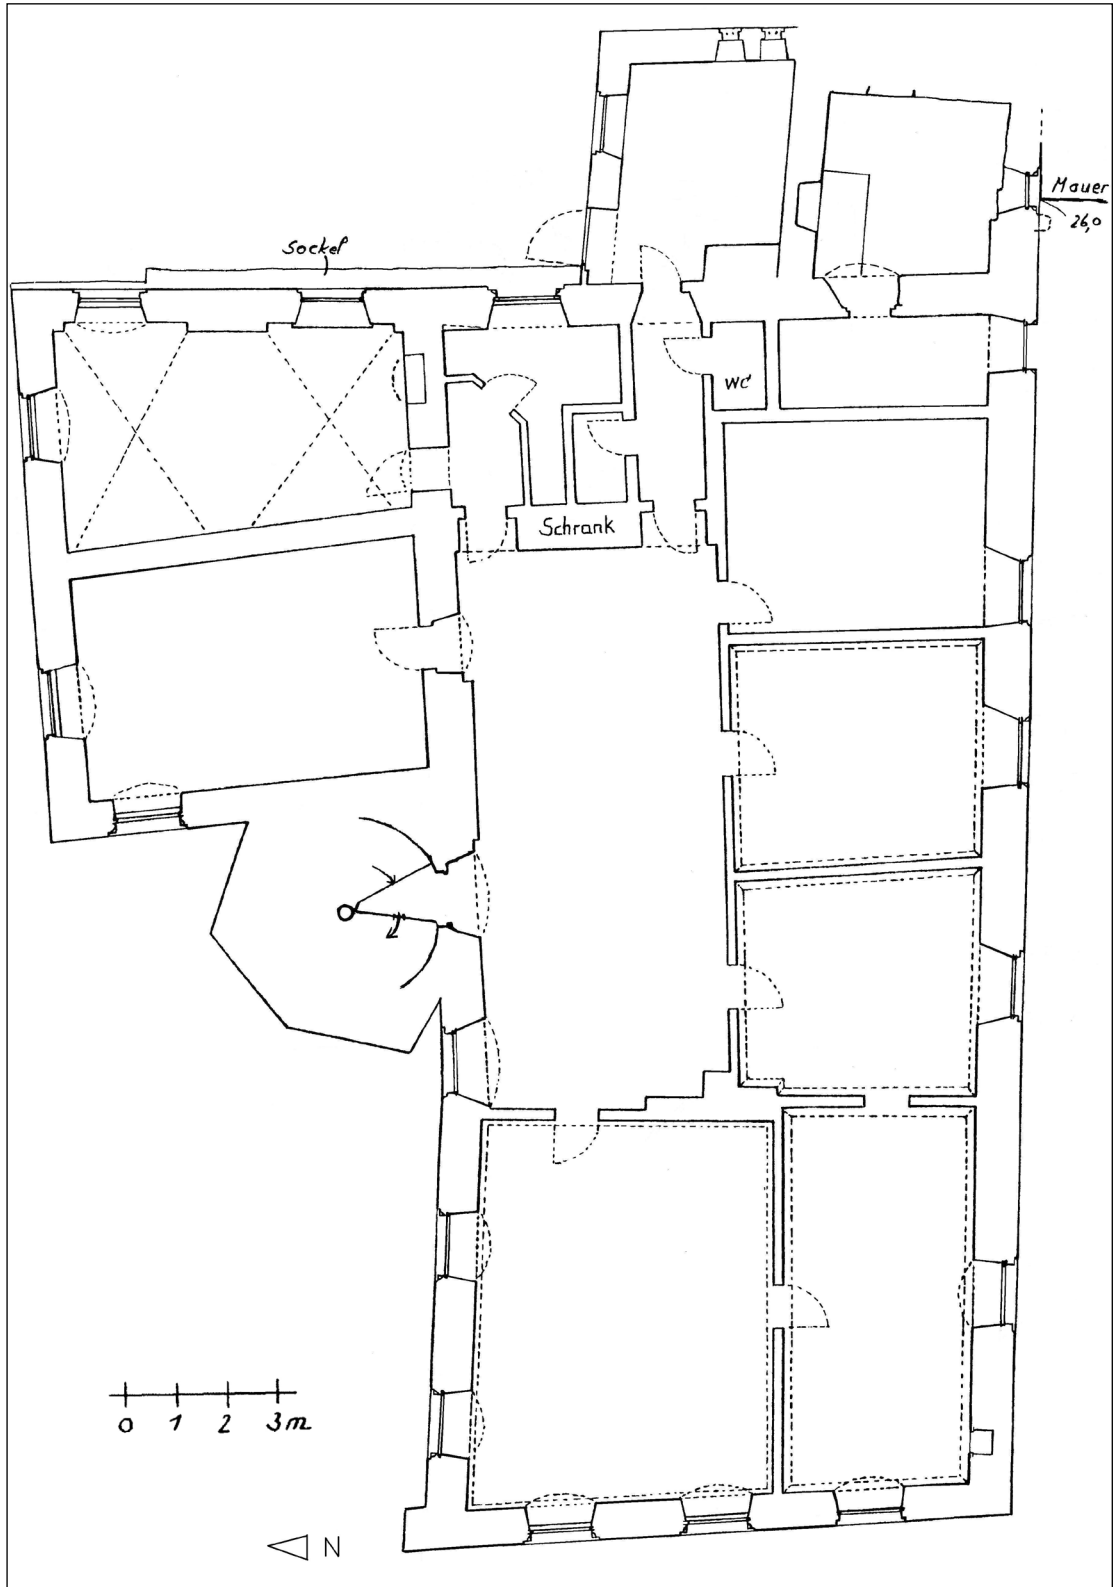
Hauptstraße 11, Grundriss Keller- und Sockelgeschoss, M. 1:150.
